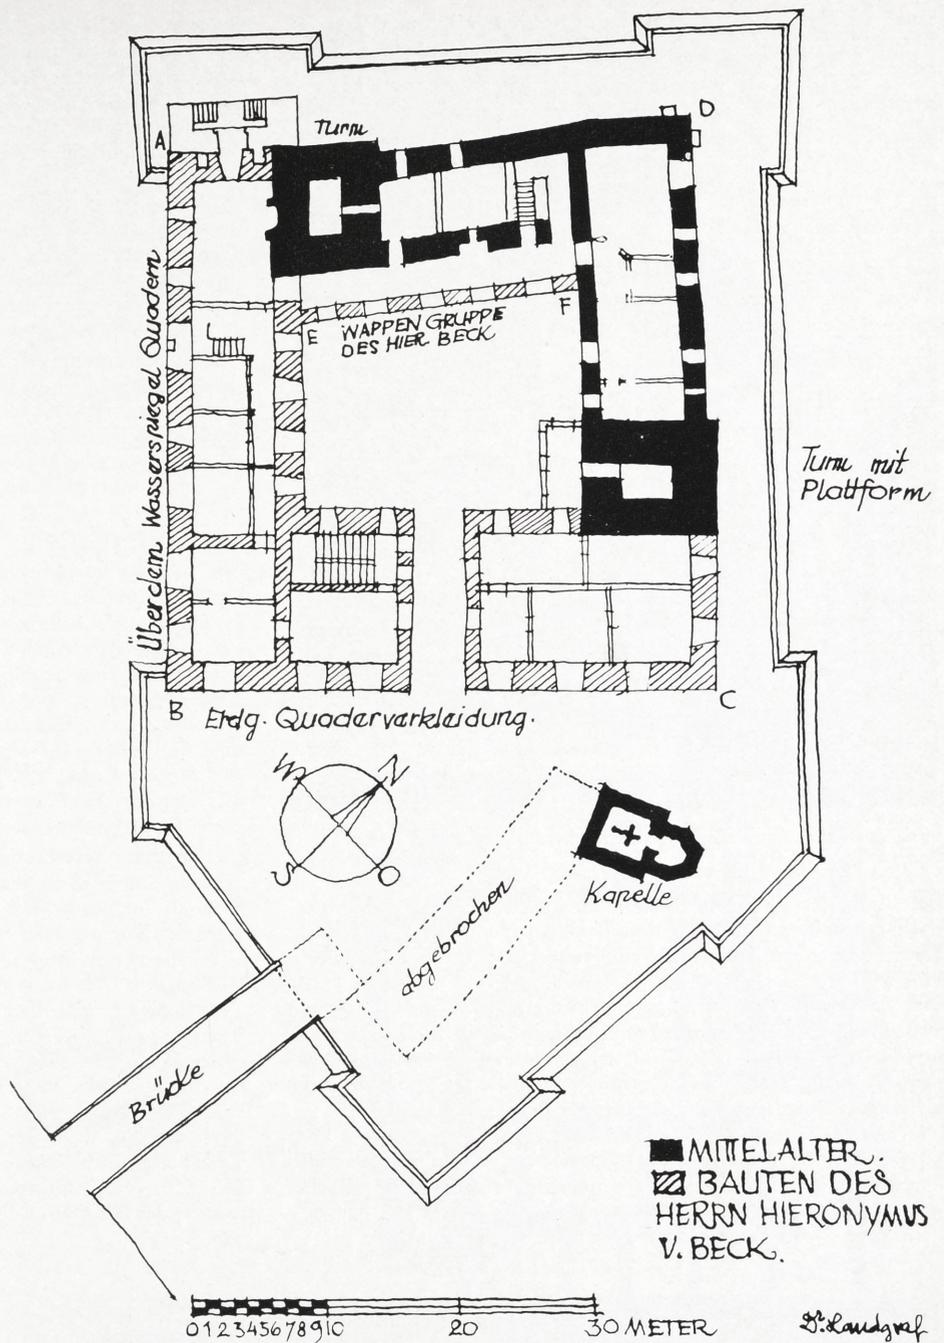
Ebreichsdorf, Grundriß Erdgeschoß, M. 1:800
